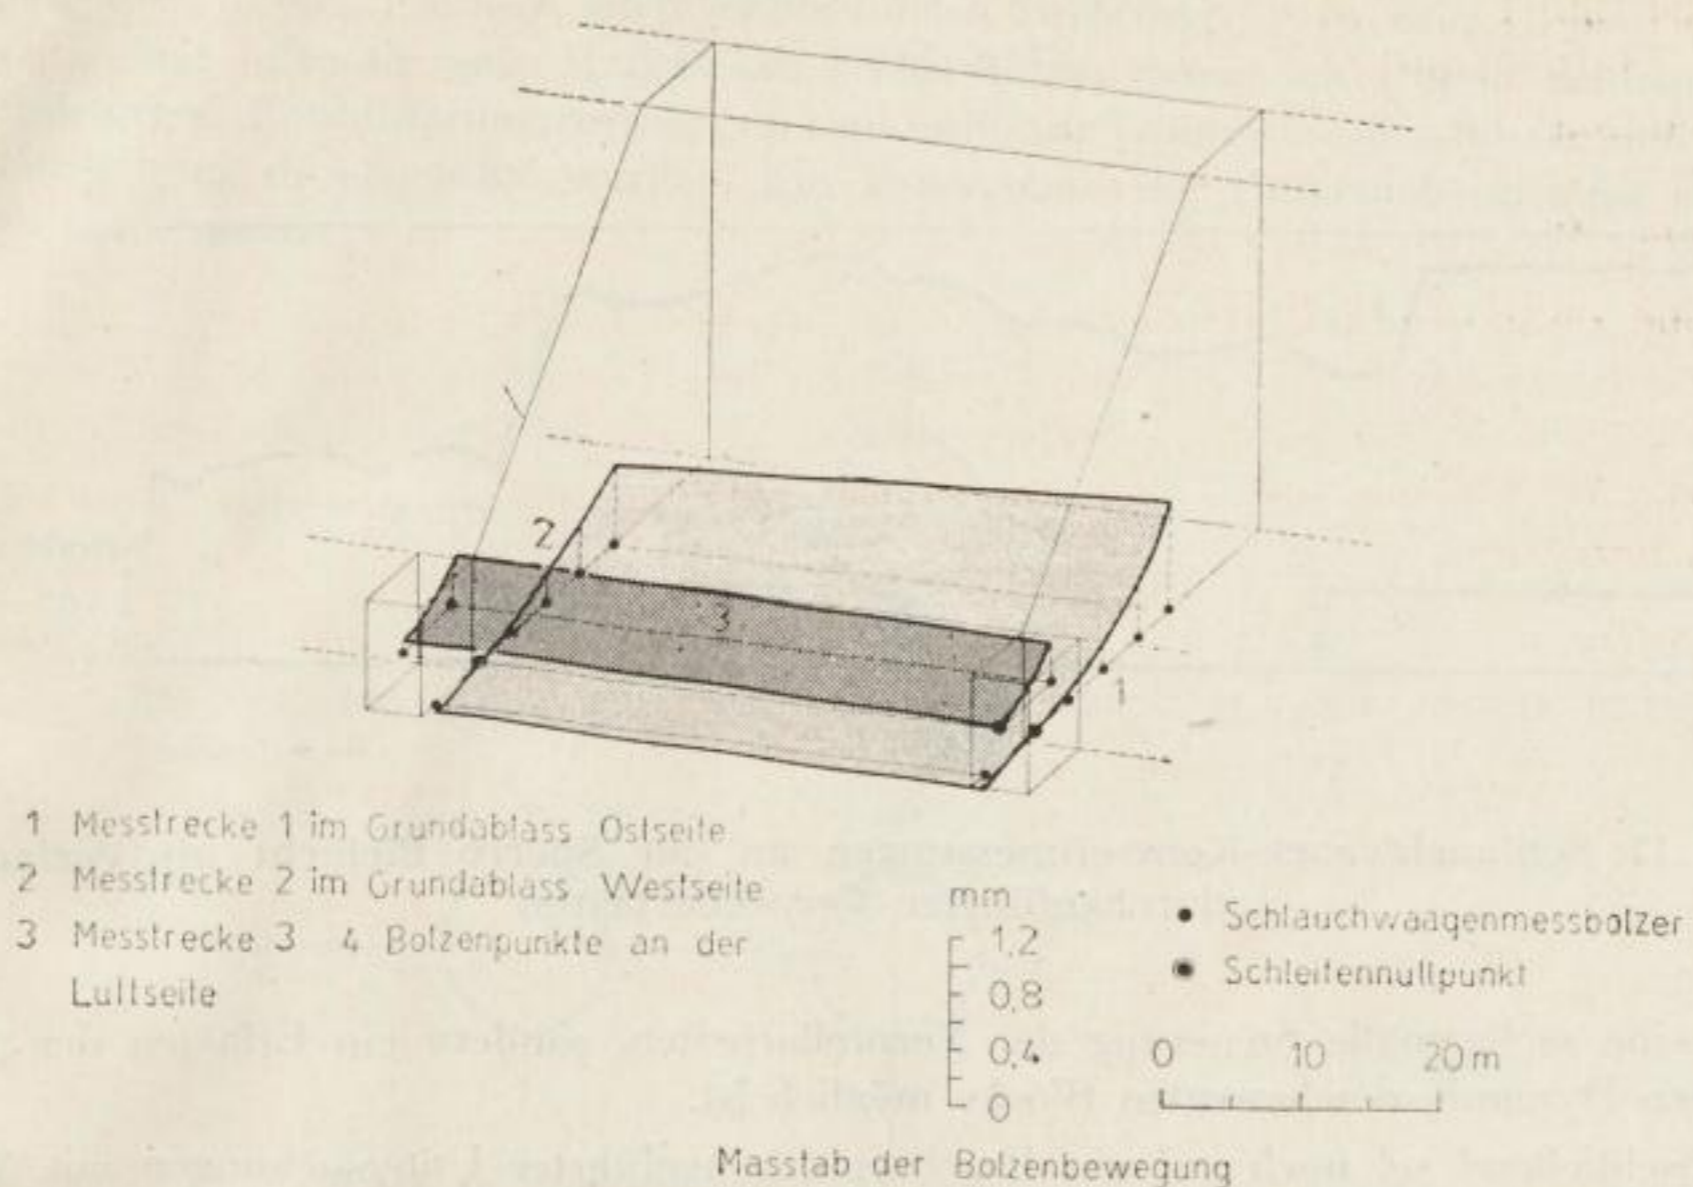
Raumbildliche Darstellung nachgewiesener, durch unterschiedliche Stauhöhen hervorgerufener Bauwerksbewegungen an der Talsperre Neunzehnhain
